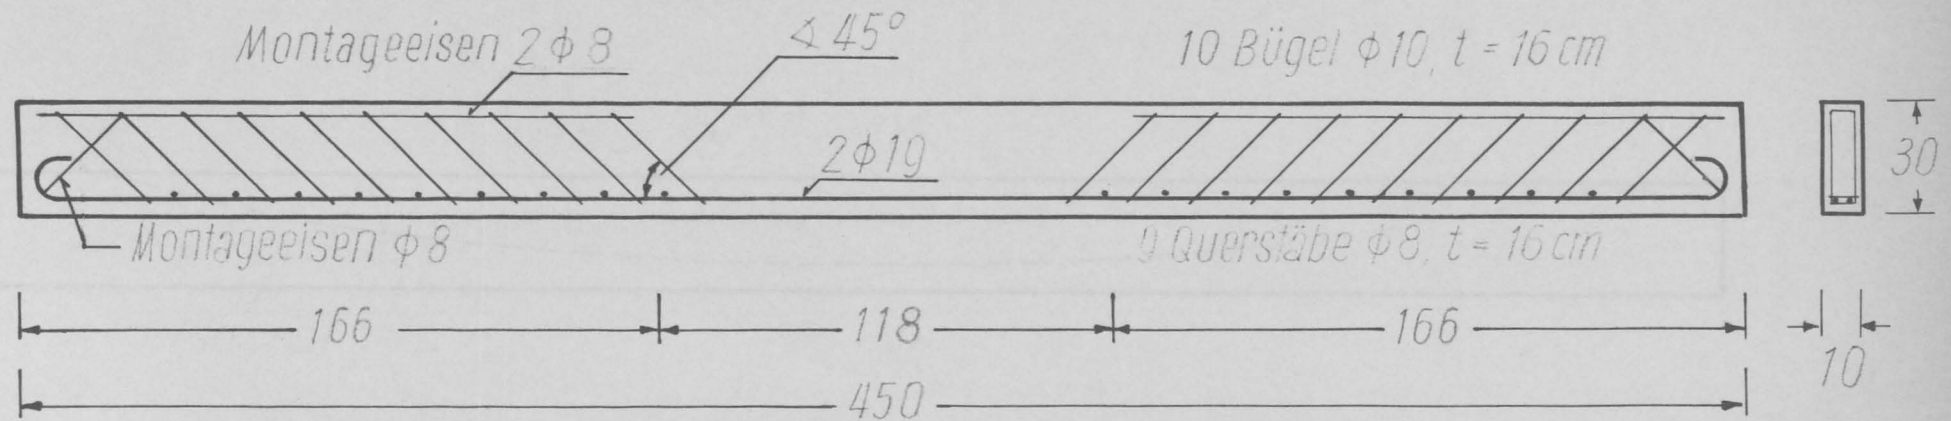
Bewehrung der Balken aus Ziegelsplittbeton bzw. Gasbeton
